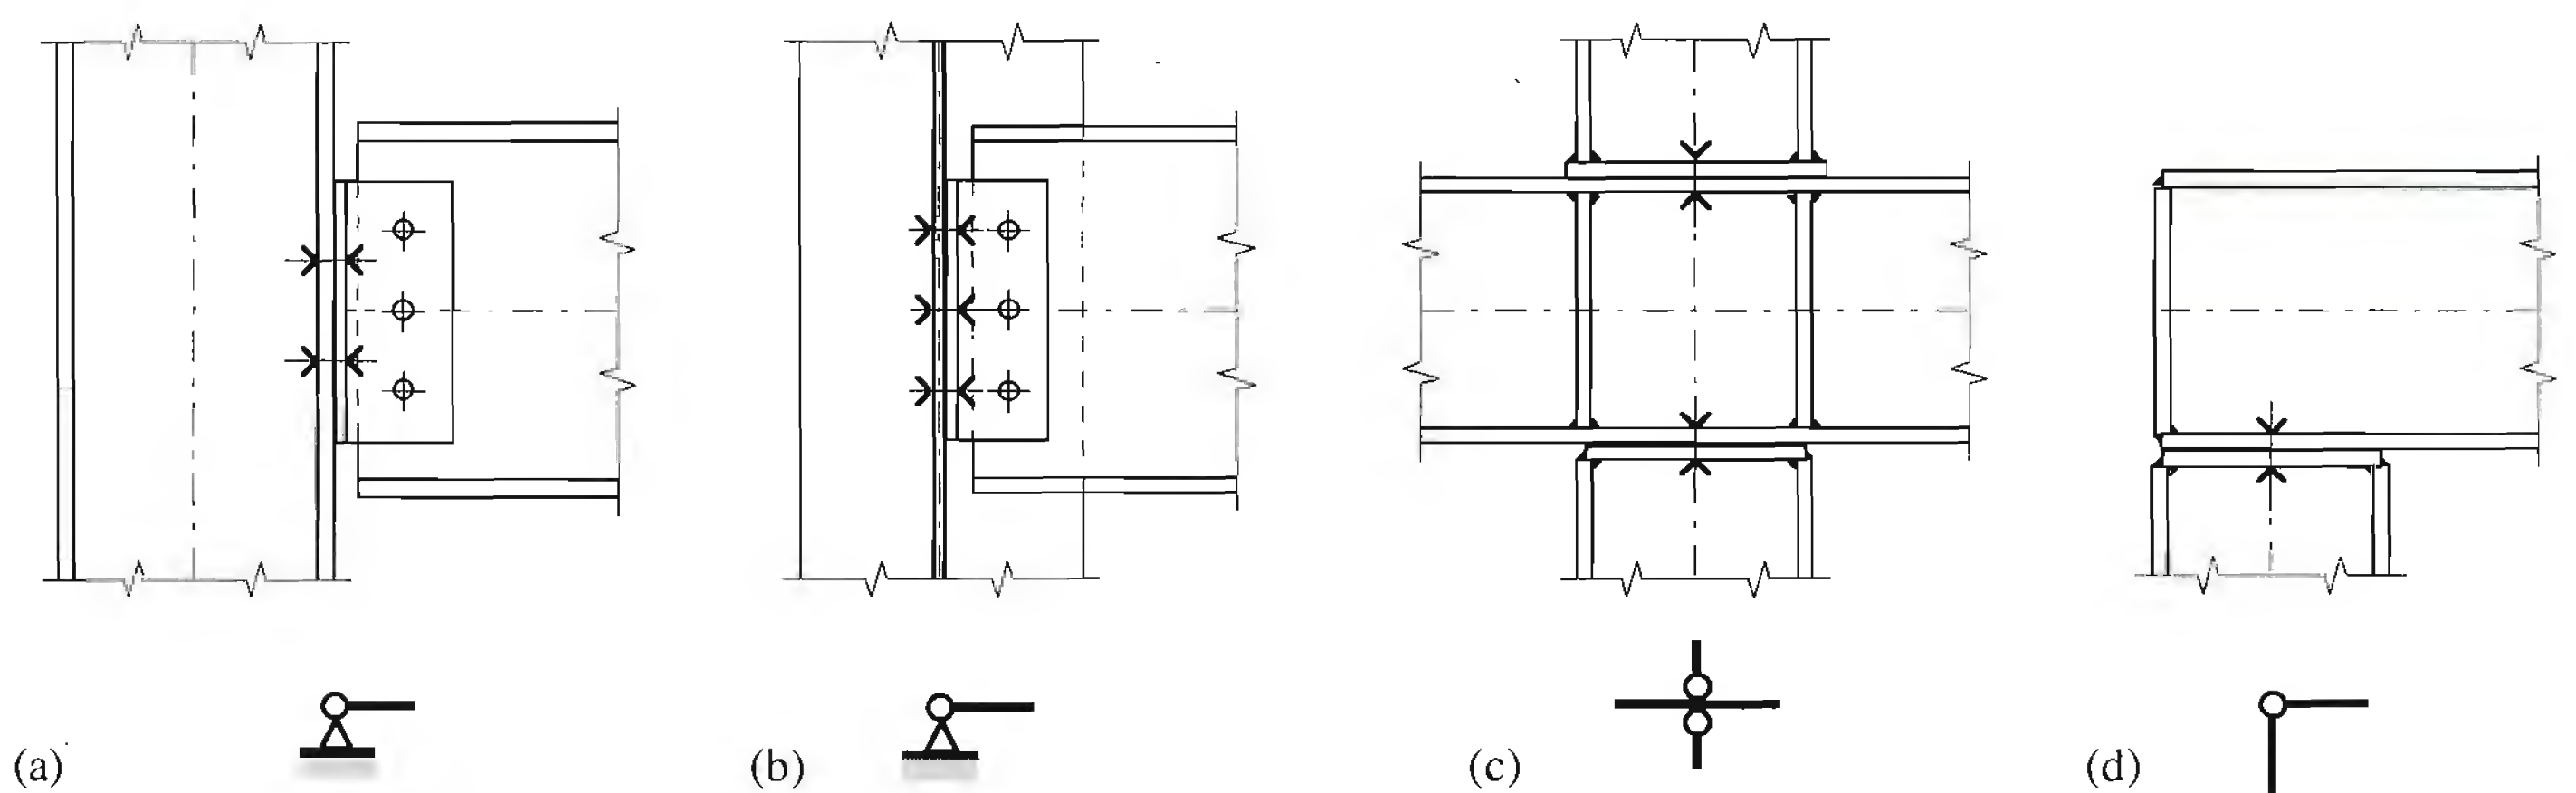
Assemblages poutre-poteau articulés et schémas des conditions d'appui.
